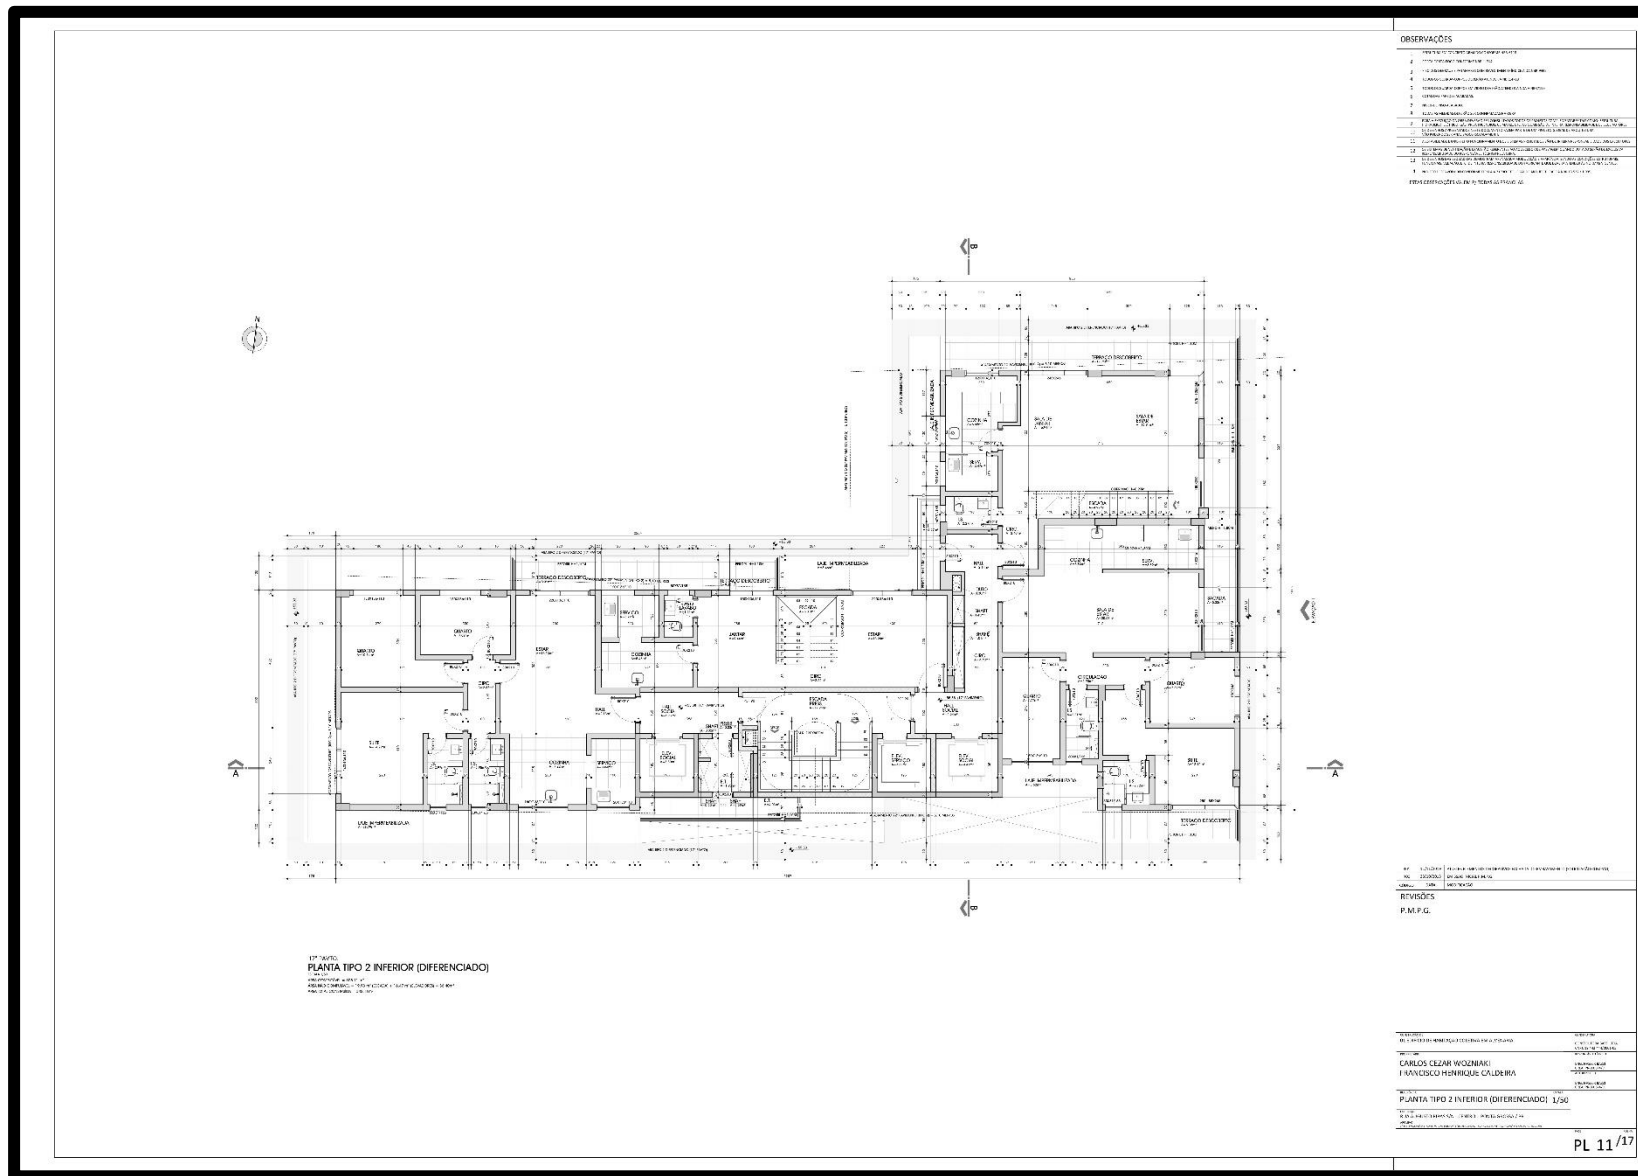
Planta pavimento tipo 2 inferior (décimo sétimo pavimento). Fonte: Construtora Bazzi (2020).
